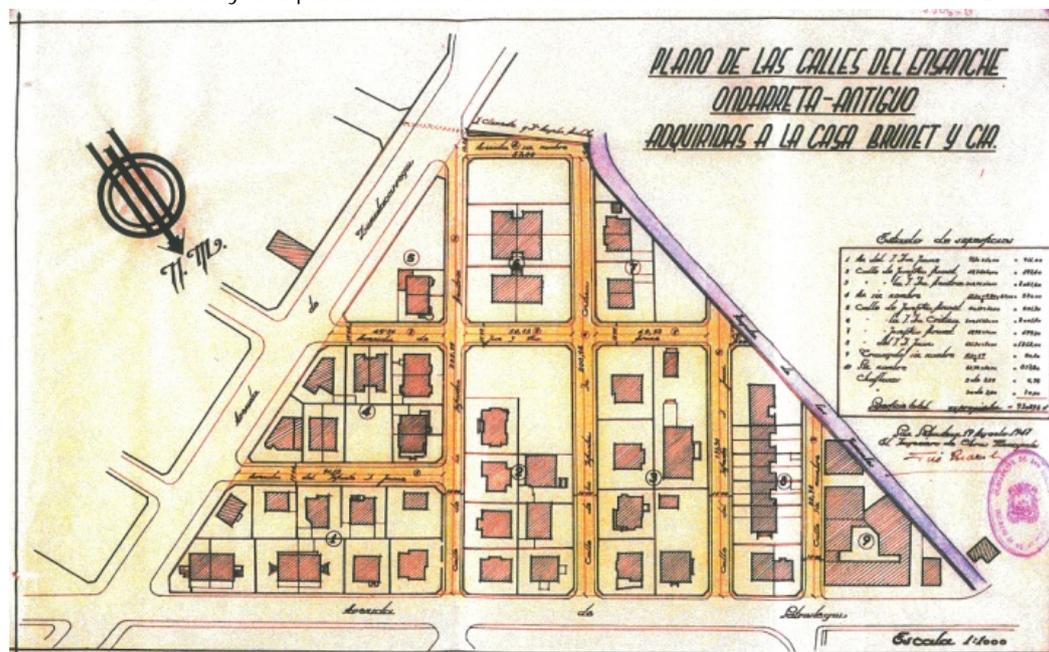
Plano de las calles del ensanche Ondarreta-Antiguo adquiridas a la casa Brunet y Cia - 1947 - A.I.G.
